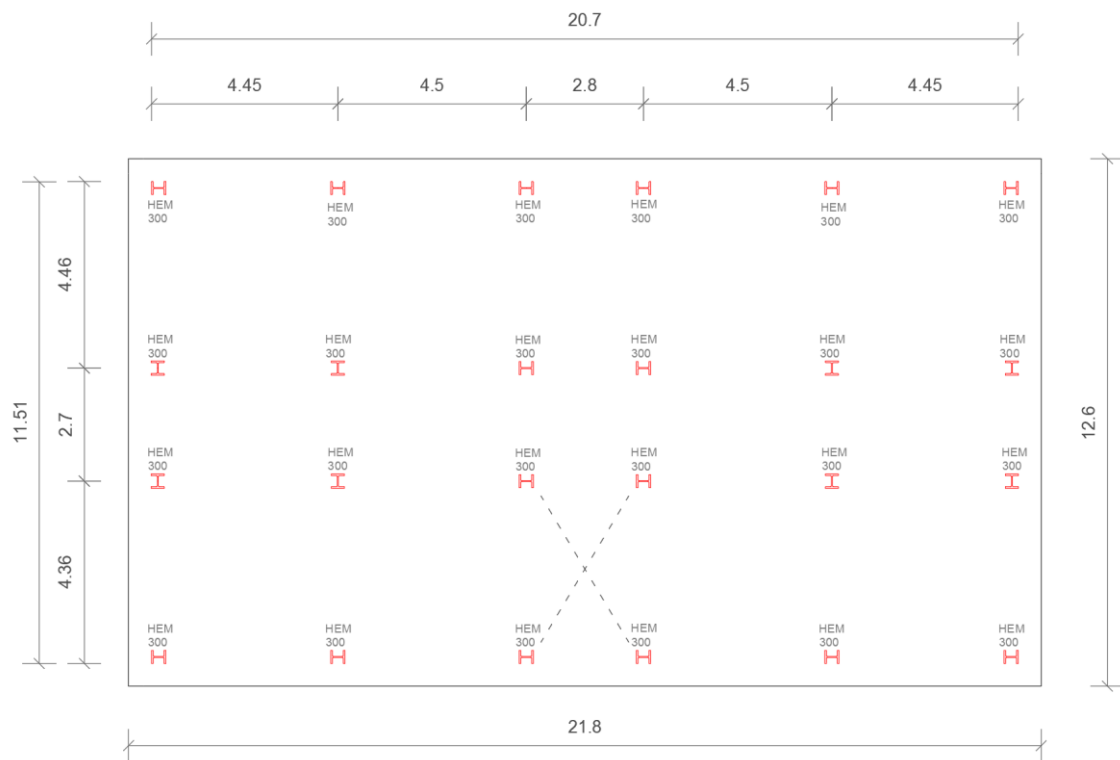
Carpenteria struttura in acciaio a tre piani con platea di fondazione.
